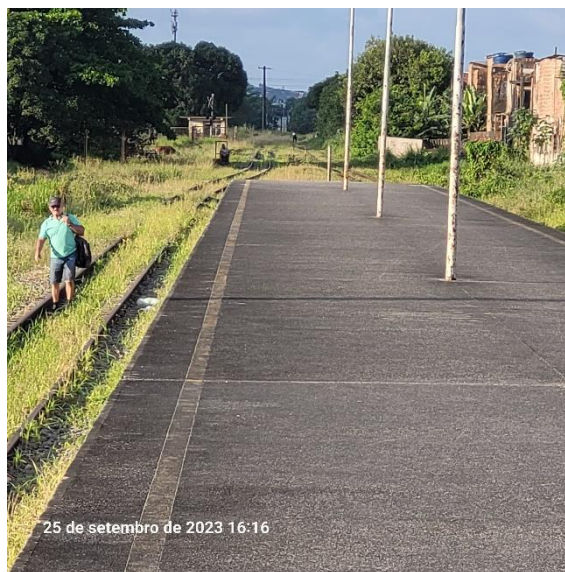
Trecho da plataforma sem cobertura e usuário caminhando pela via
